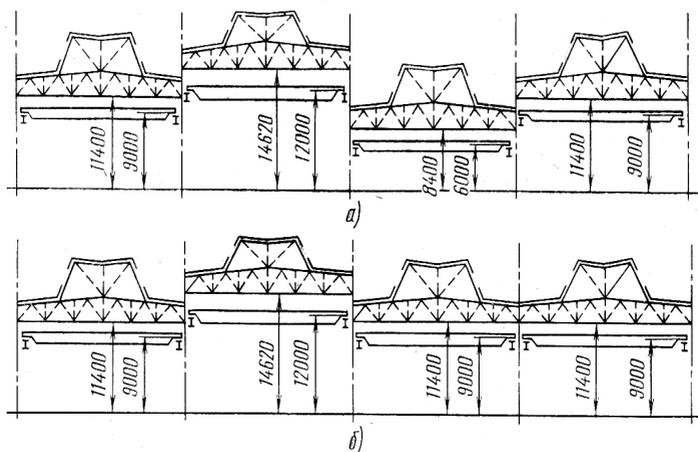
Поперечное сечение пролетов узловой сборки и сварки при планировке цеха со смешанным направлением производственного потока: *a* – неправильно; *б* – правильно
